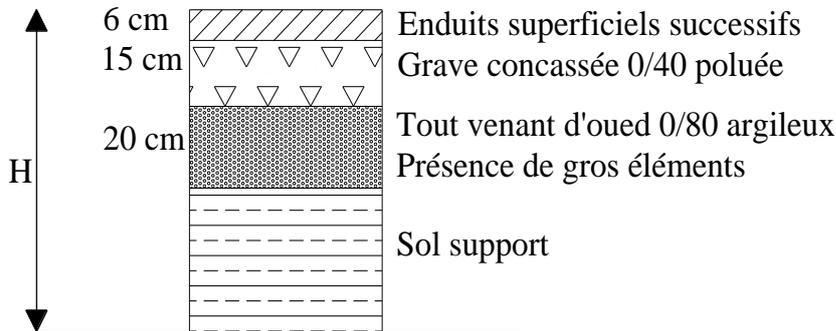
coupe d'un sondage[LCPC-SETRA 2007]
